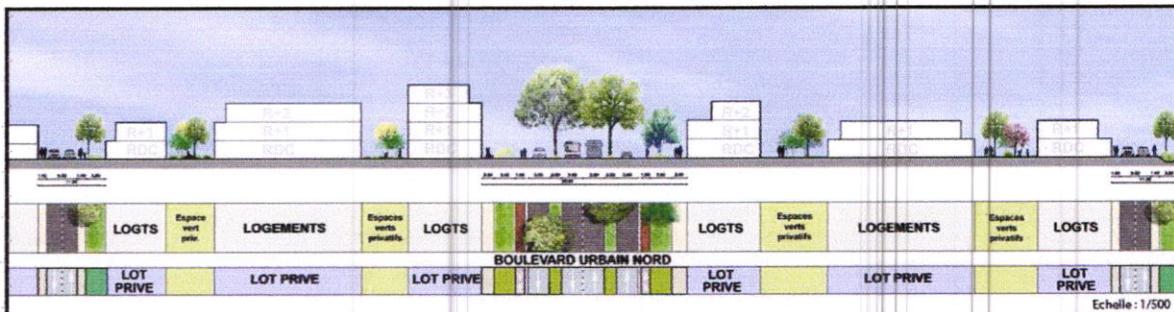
(2.2): Profil a travers d'un boulevard urbain.
